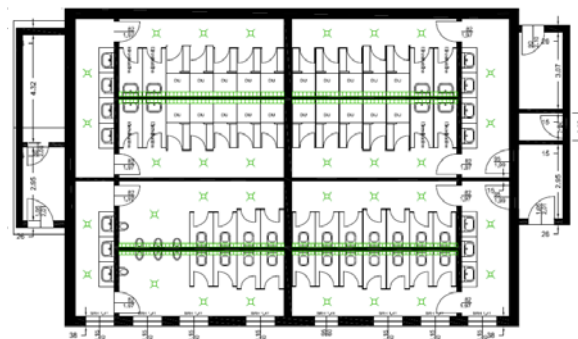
Beispielgrundriss Sanitärgebäude, Planung Campingplatz Westerland
